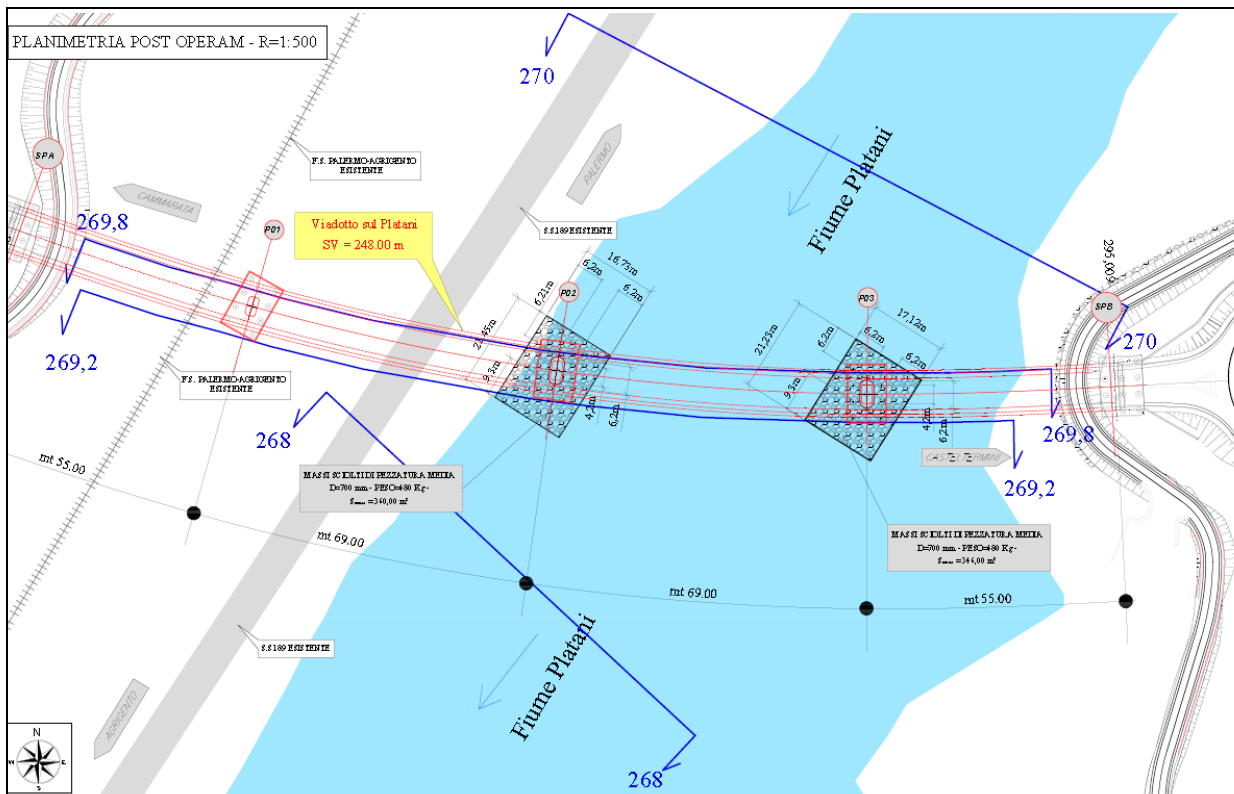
Planimetria Viadotto sul Platani con indicazione delle pile coinvolte dalla Piena con Tempo di Ritorno di 300 anni.
